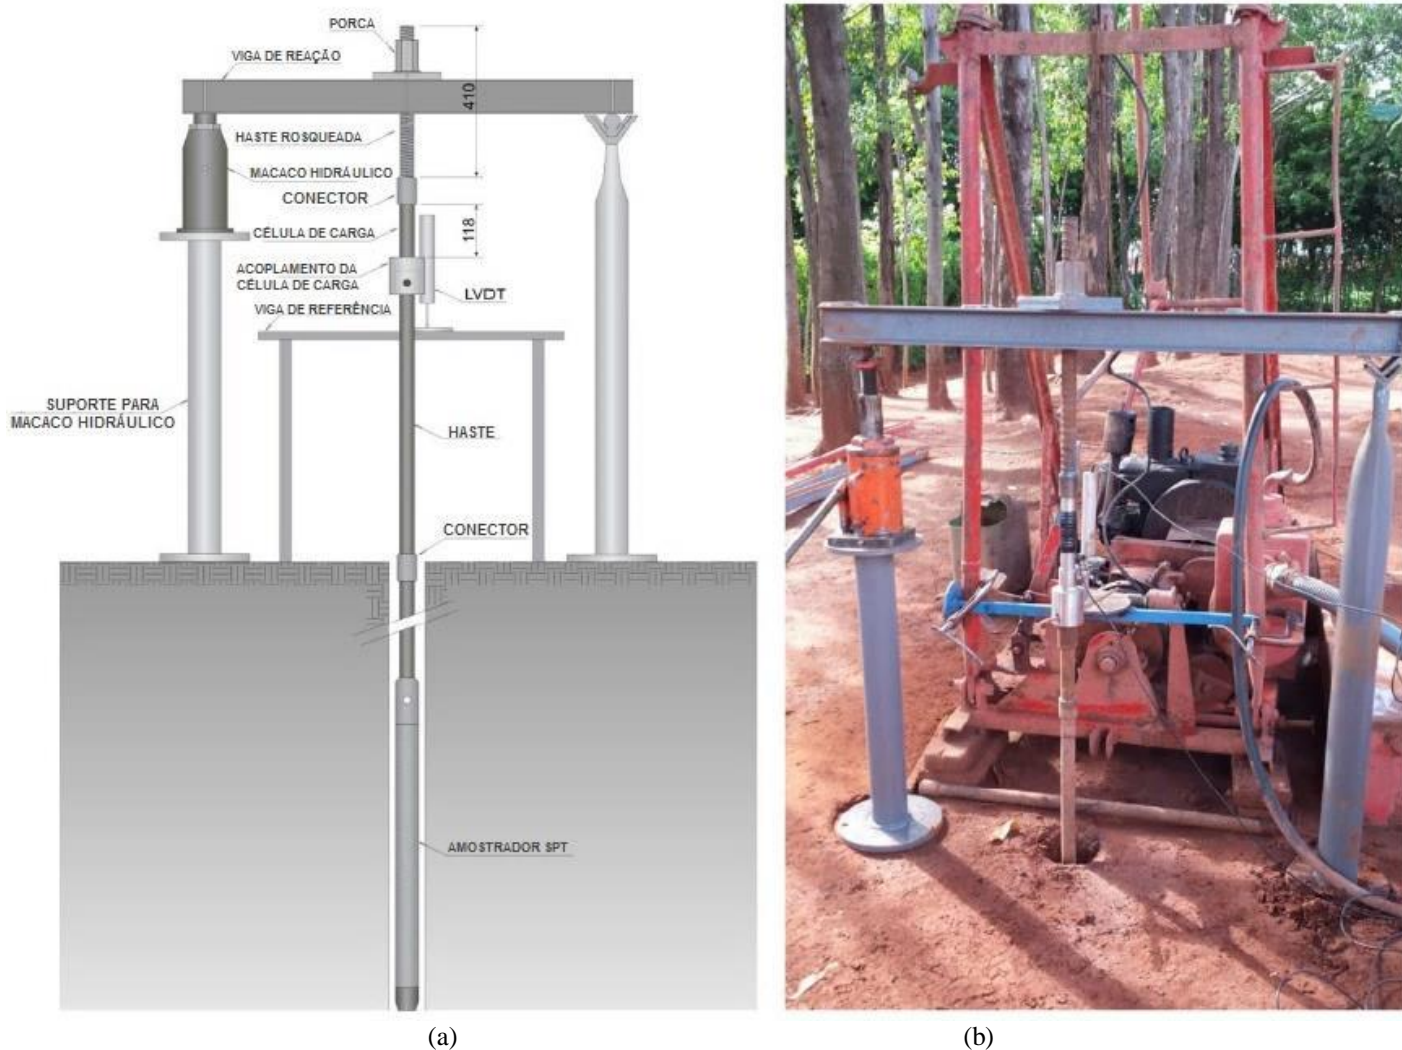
Equipamentos para ensaios de arrancamento: (a) desenho esquemático e (b) montagem do ensaio.
